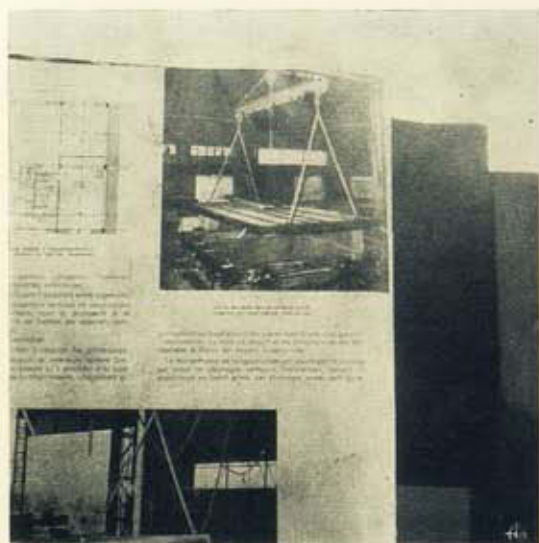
Elevação da cobertura de aquecimento após o fabrico de um elemento.
